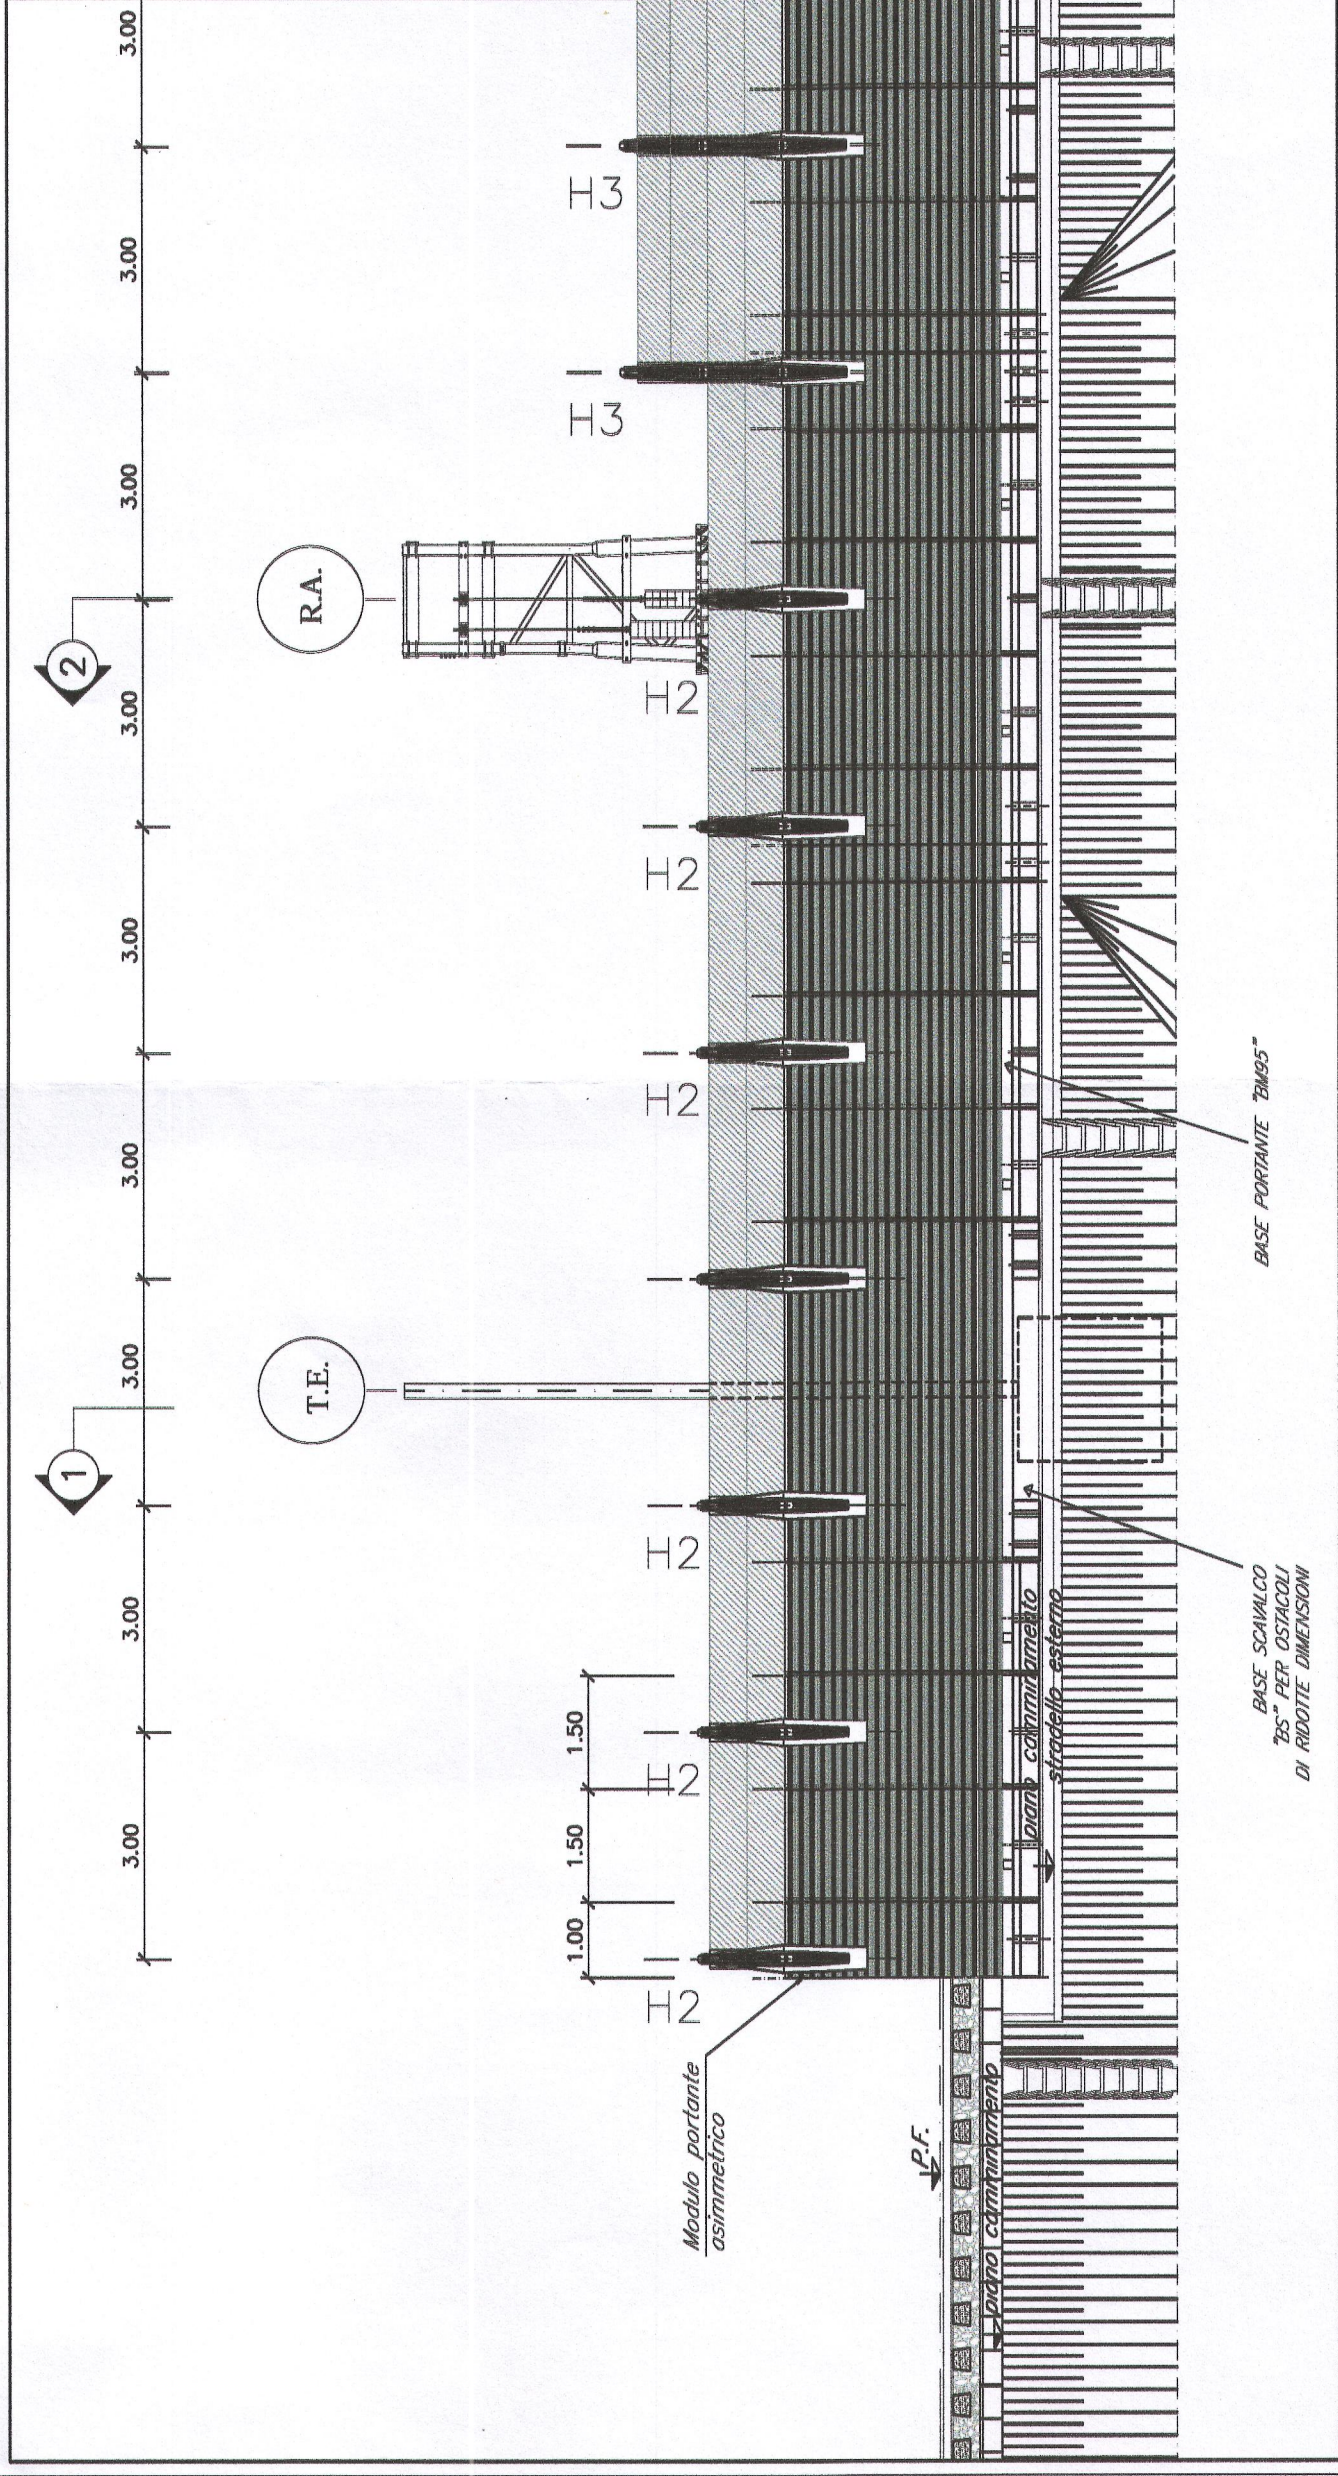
Stralcio del prospetto delle barriere fonoassorbenti
